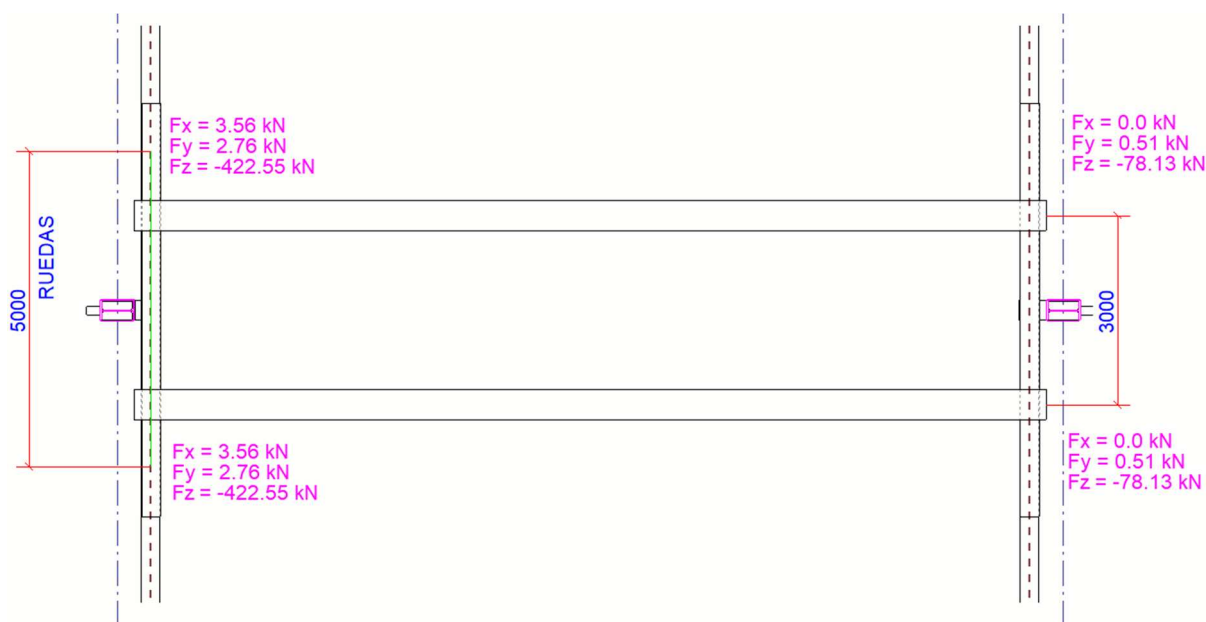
Tren de cargas aplicada a las vigas carrileras.
